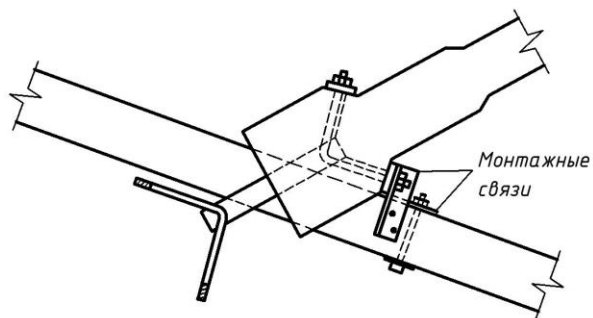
Конструкция крепления крайних узлов полотнища монтажными связями
